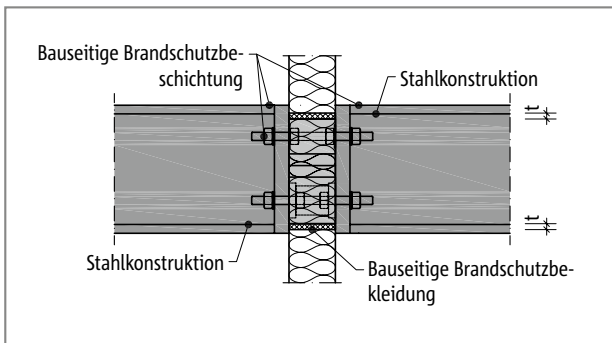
Brandschutz Schöck Isokorb® T Typ S: Bauseitige Brandschutzbekleidung T Typ S, brandschutzbeschichtete Stahlkonstruktion; Schnitt
